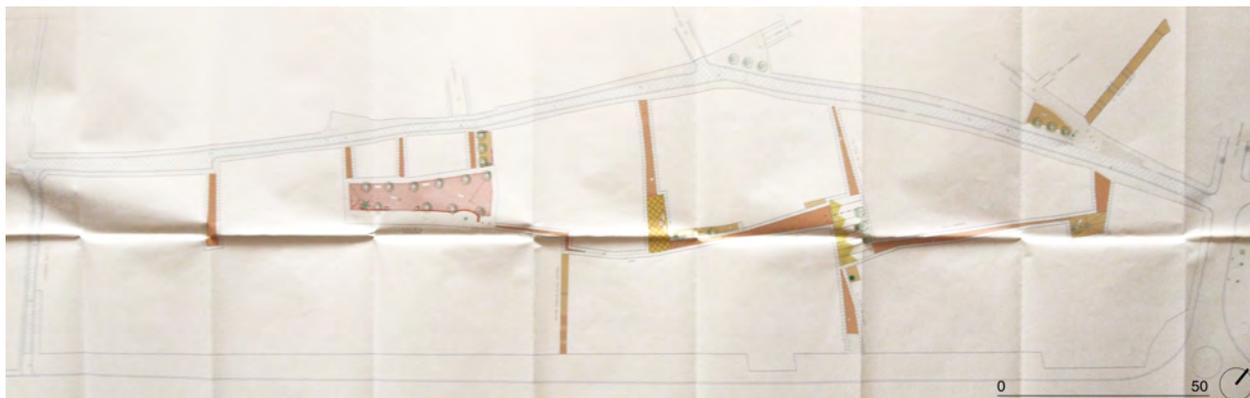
Planta de la Fase 1 del Plan Urban Ribera.
